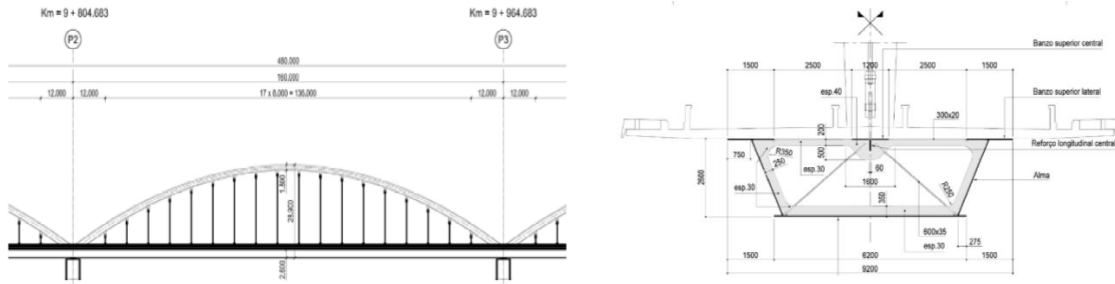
Travessia ferroviária sobre o Rio Sado - perfil longitudinal (esquerda) e secção transversal (direita) [16] [17]
